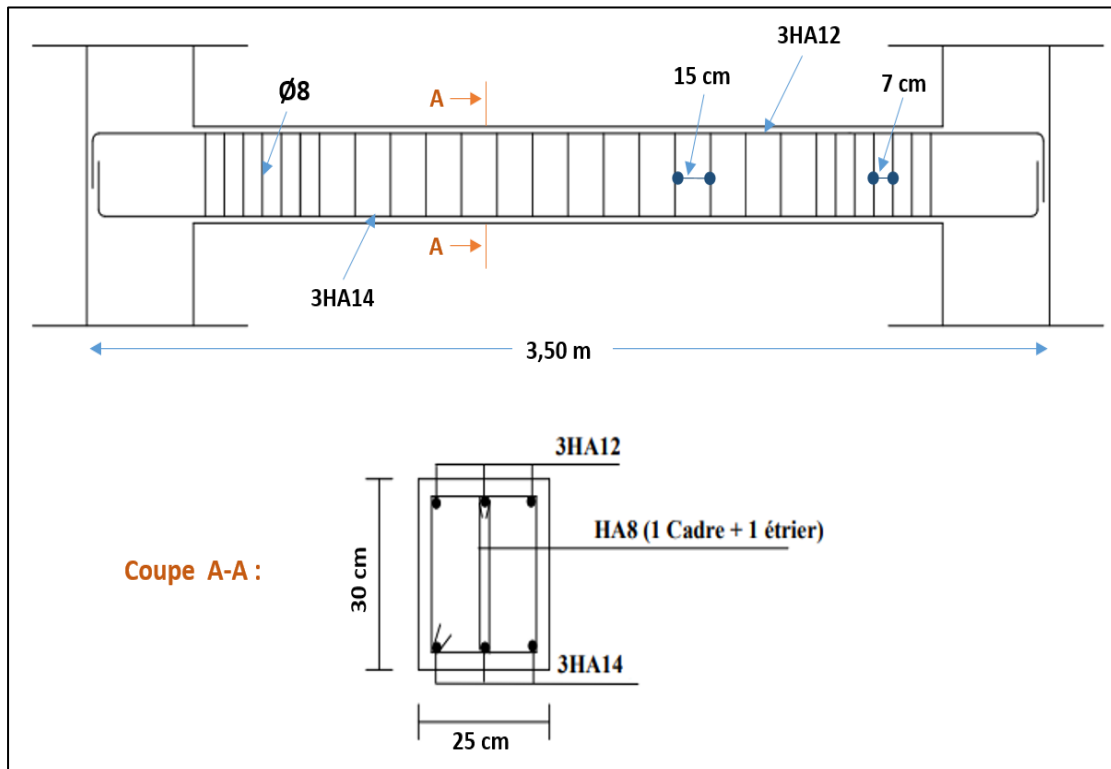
65 : Schémas de ferrailage de la poutre palière.
